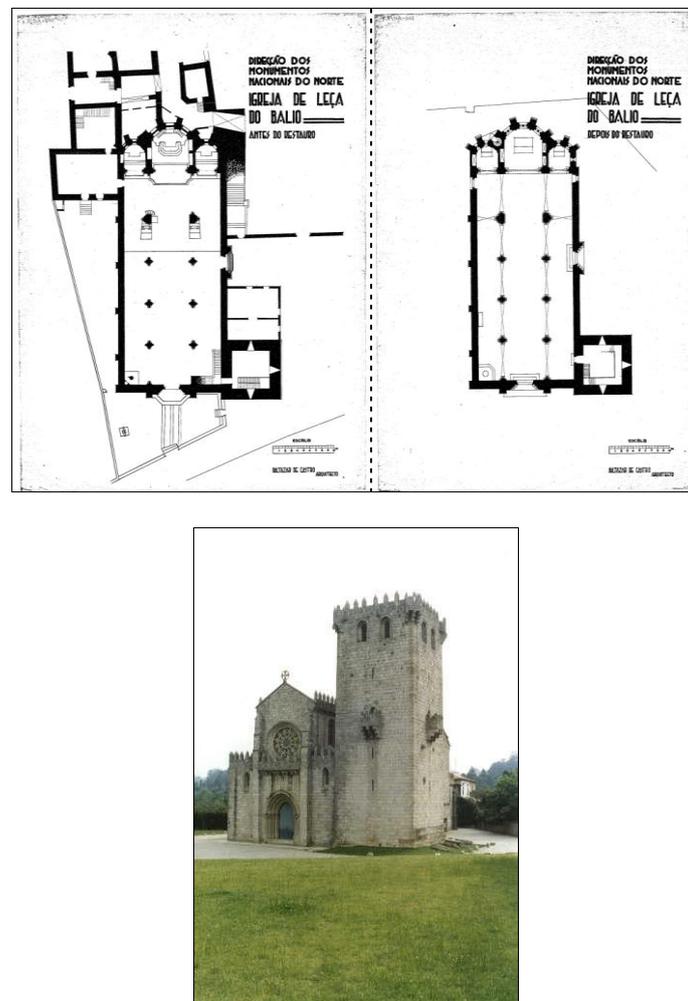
Igreja da Leça do Balio, Matosinhos, Porto. Planta antes do restauro (esquerda); planta depois do restauro (direita) e vista exterior
